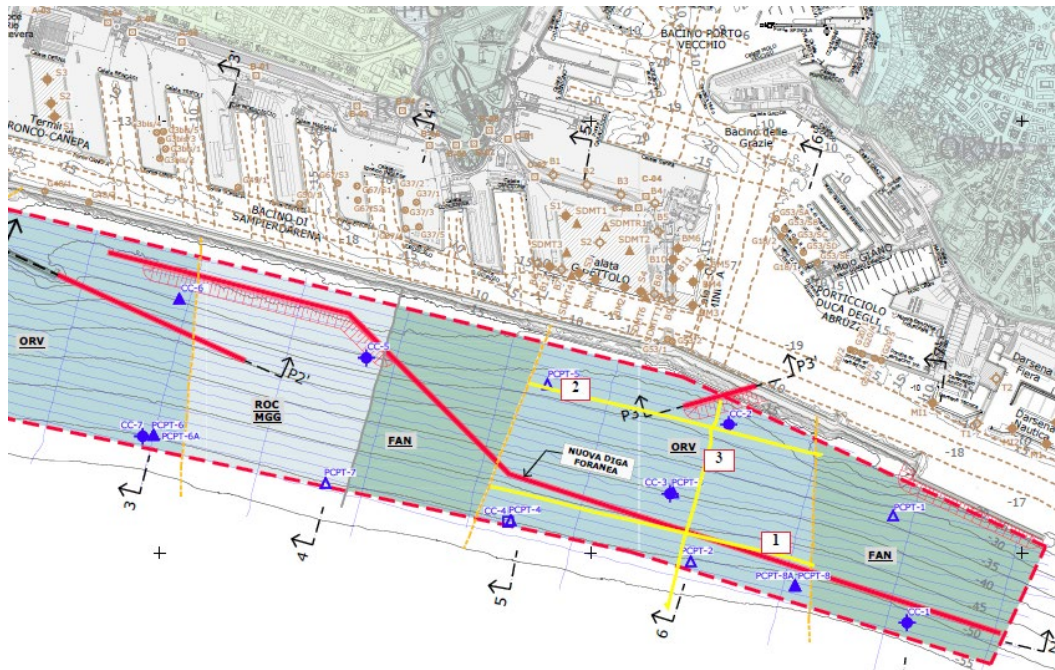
INDAGINE SPARKER DI PFTE – PLANIMETRIA DI UBICAZIONE DI TUTTE LE TRACCE (BLU) CON IN GIALLO QUELLE CONSIDERATE N.1, 2, 3
